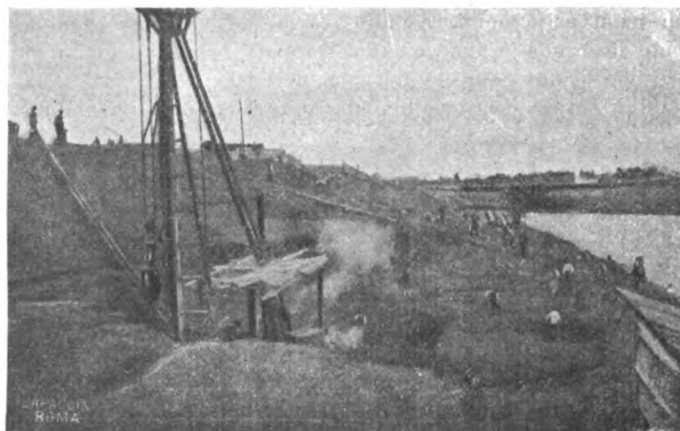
Inizio delle fondazioni sulla sponda destra.
